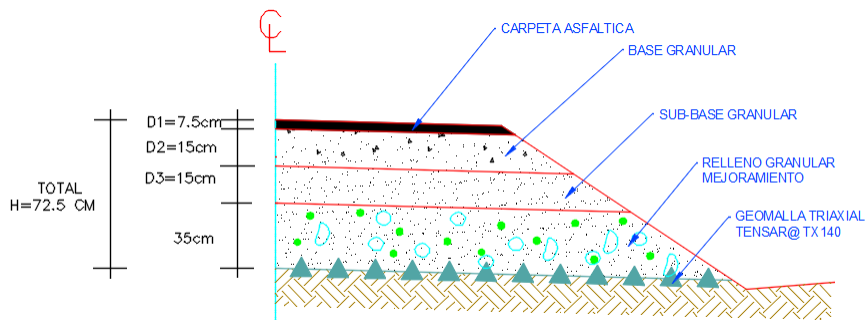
Paquete Estructural Obtenido con Refuerzo de Geomalla
